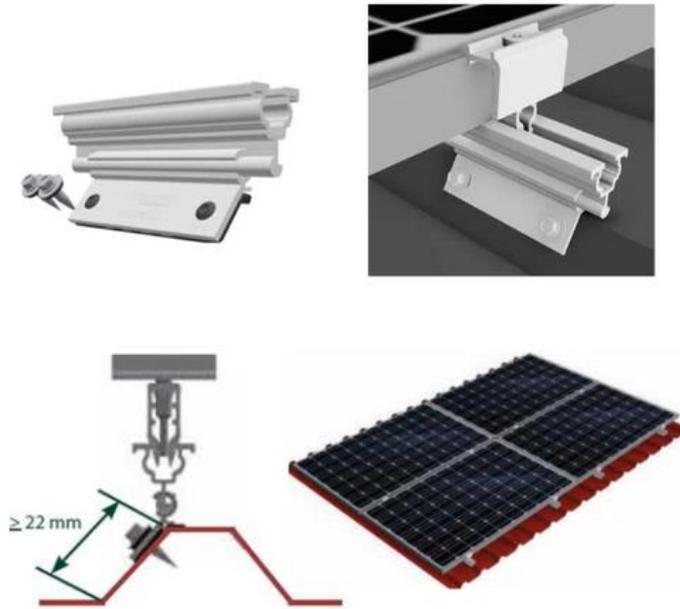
Clampfit de Schleter, para cubierta metálica coplanar con anclaje a chapa
